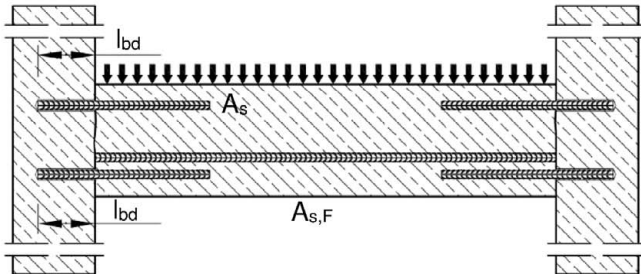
Bewehrungsanschlüsse überwiegend auf Druck beanspruchter Bauteile; Bewehrungsstäbe auf Druck beansprucht
